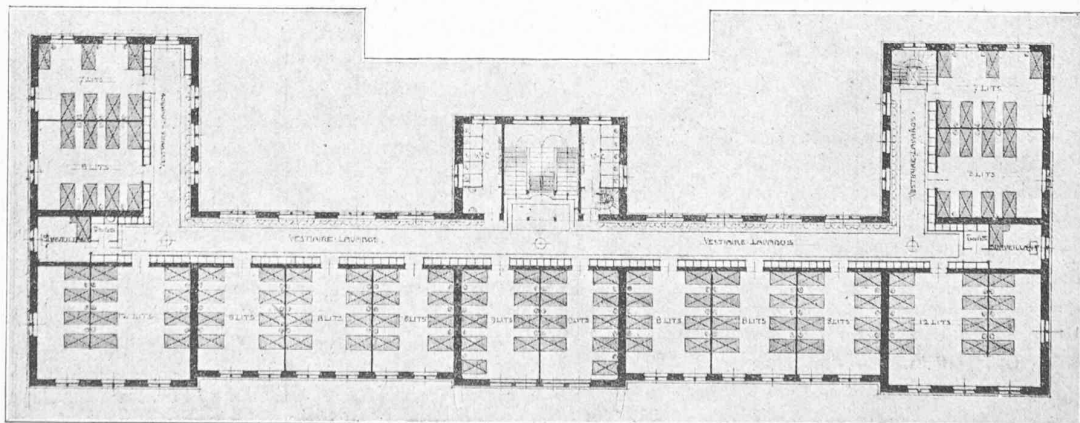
Plan du 1er Etage. — 1 : 500.
